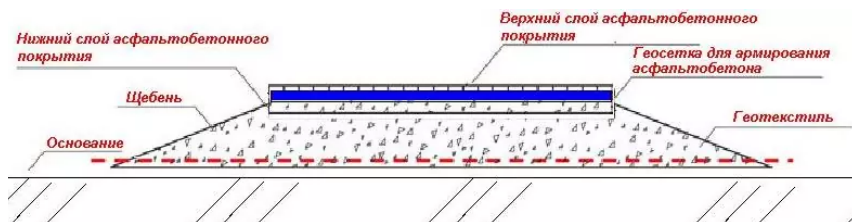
Пример конструкции дорожной одежды с использованием геотекстиля для армирования асфальтобетона
